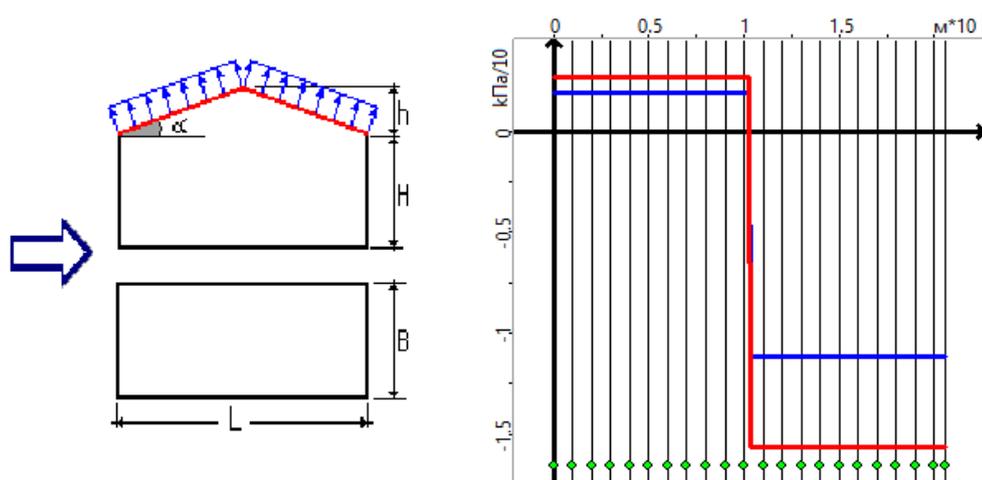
Расчетная схема определения ветровой нагрузки на кровлю
